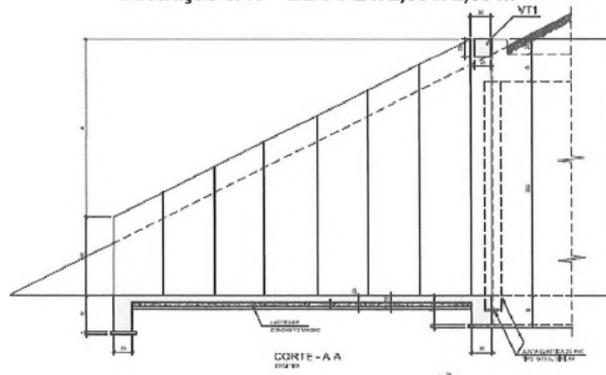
Boca de BDCC 2 x 2,50 x 2,50 m
